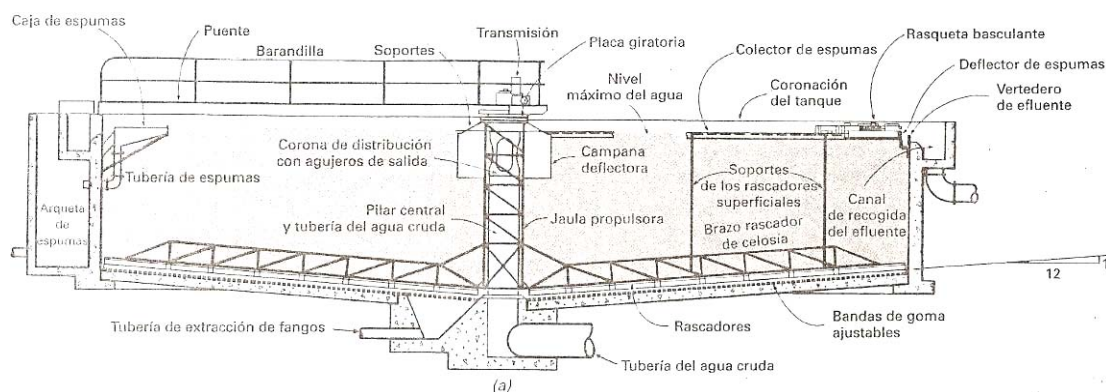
Tanques circulares de decantación primaria: de alimentación central (de infilco Degremont)
